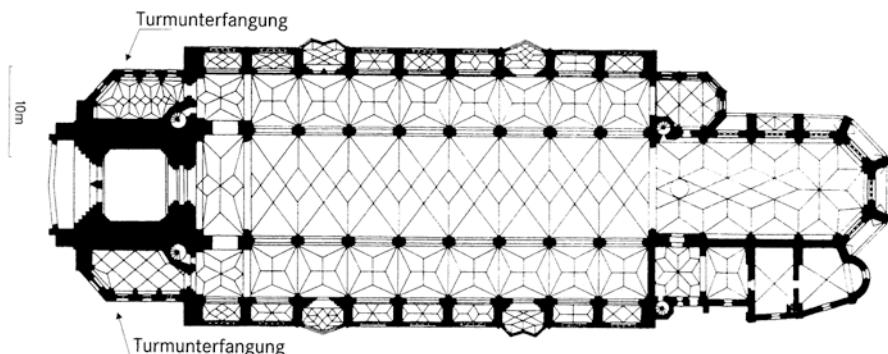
Landshut, Stadtkirche St. Martin. Grundriss mit Eintrag der Turmunterfangungen
